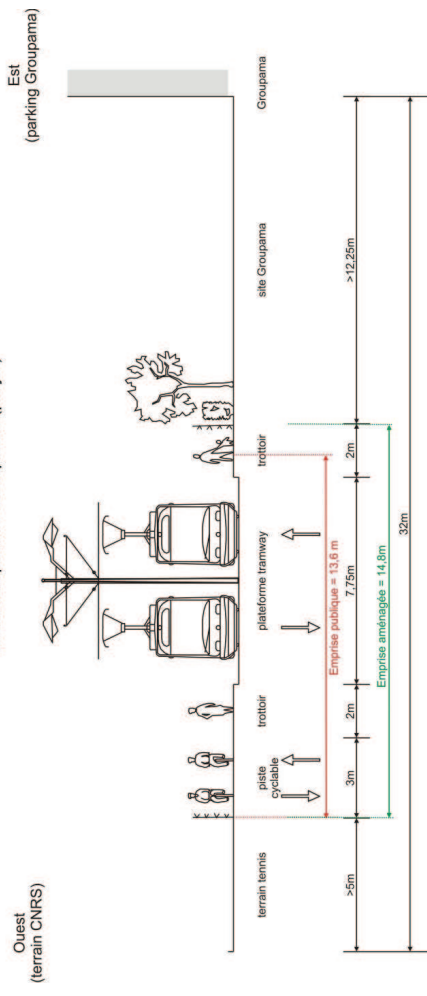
Situation projetée (coupe 15) sur la rue Becquerel
